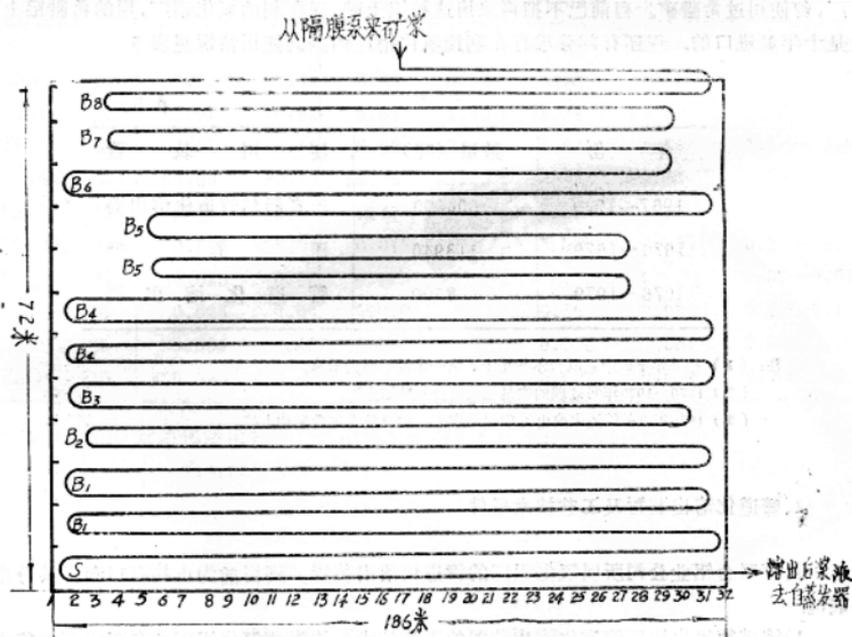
施塔德氧化铝厂管道化溶出装置平面图
